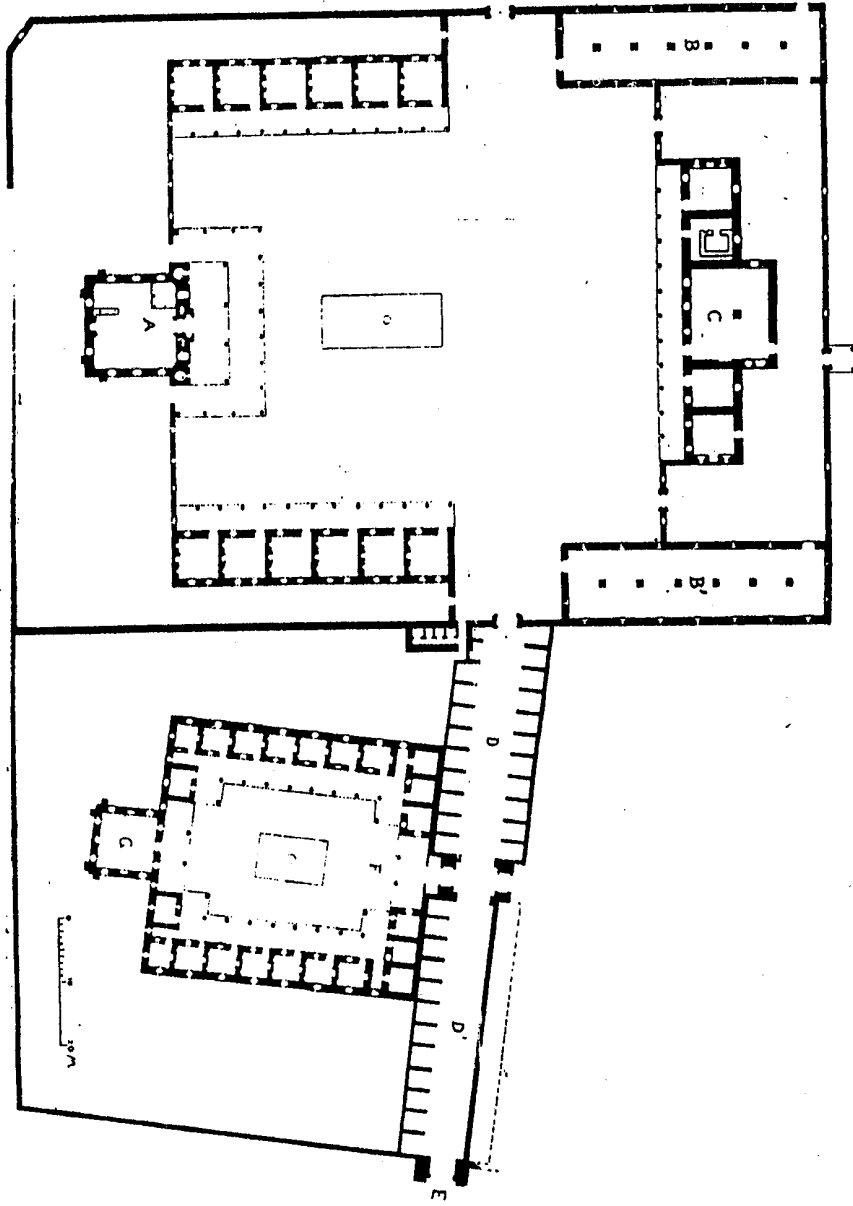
مسقط أفقي لمدارس السلطان سليمان القانوني ضمن مجمعه (كليته)
